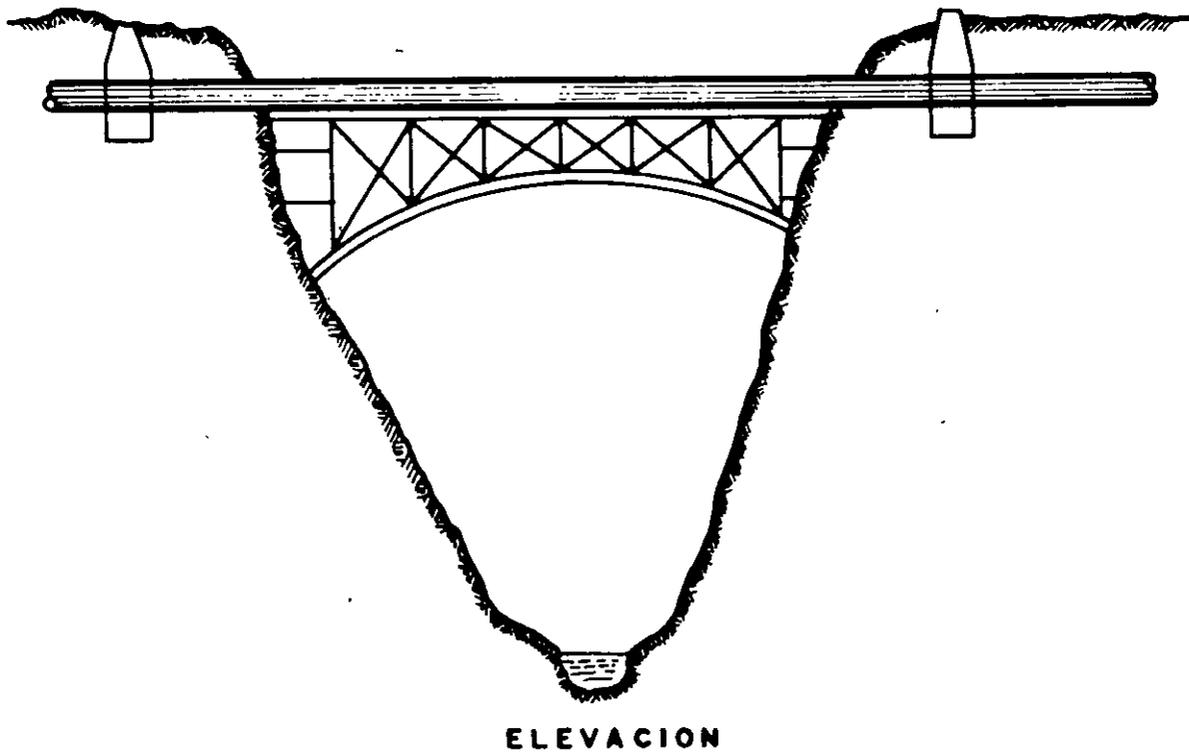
ESTRUCTURA PARA CRUCE ELEVADO
